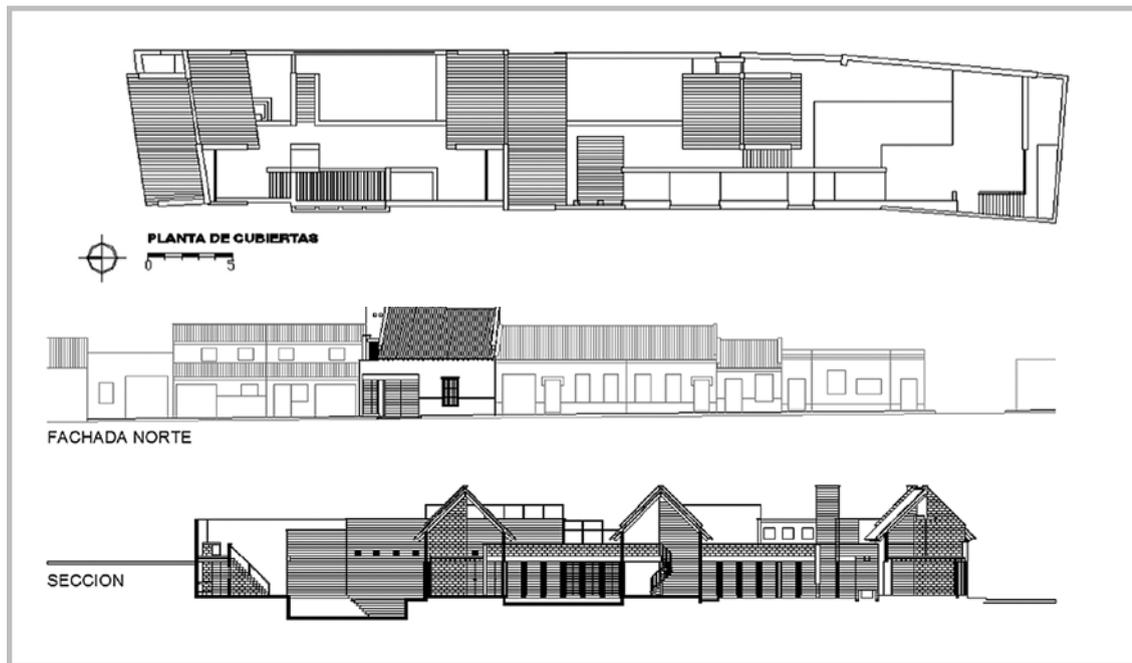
Planta cubiertas, fachada y corte casa "La Queja". Fuente: Planos Benjamín Barney (2010)
